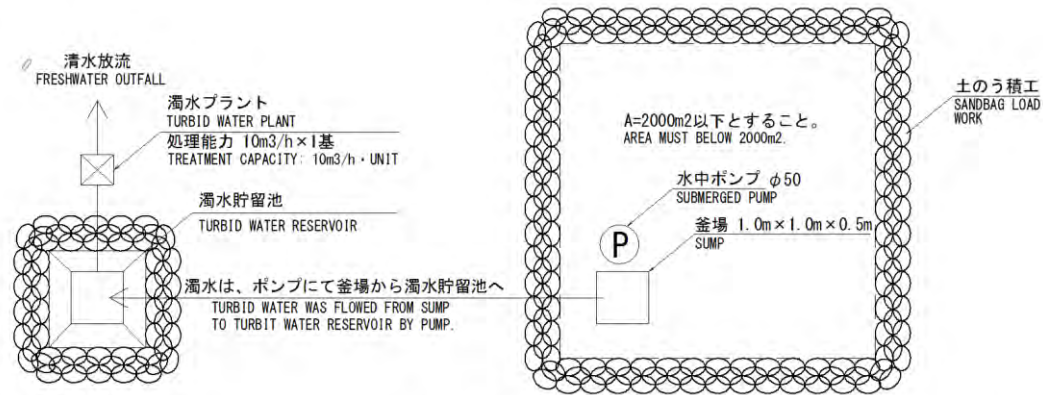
(1) 赤土等流出対策工事平面図 (II工区)
